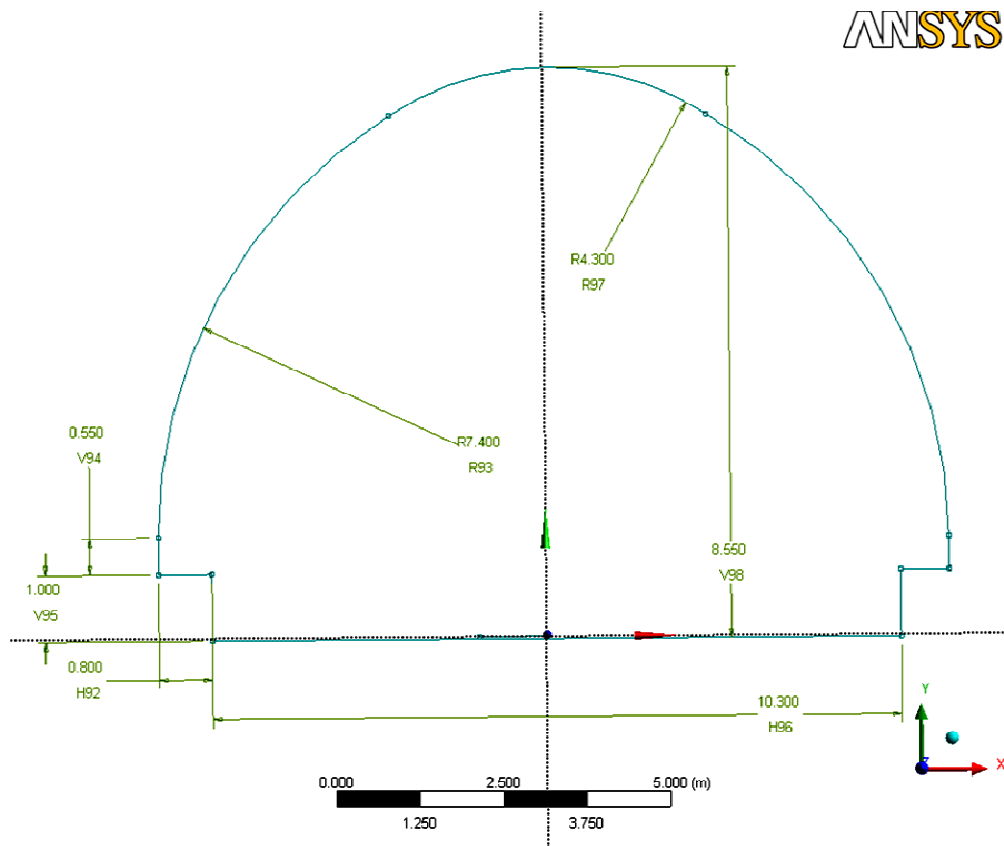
Dimensões da face transversal do túnel Rebouças
